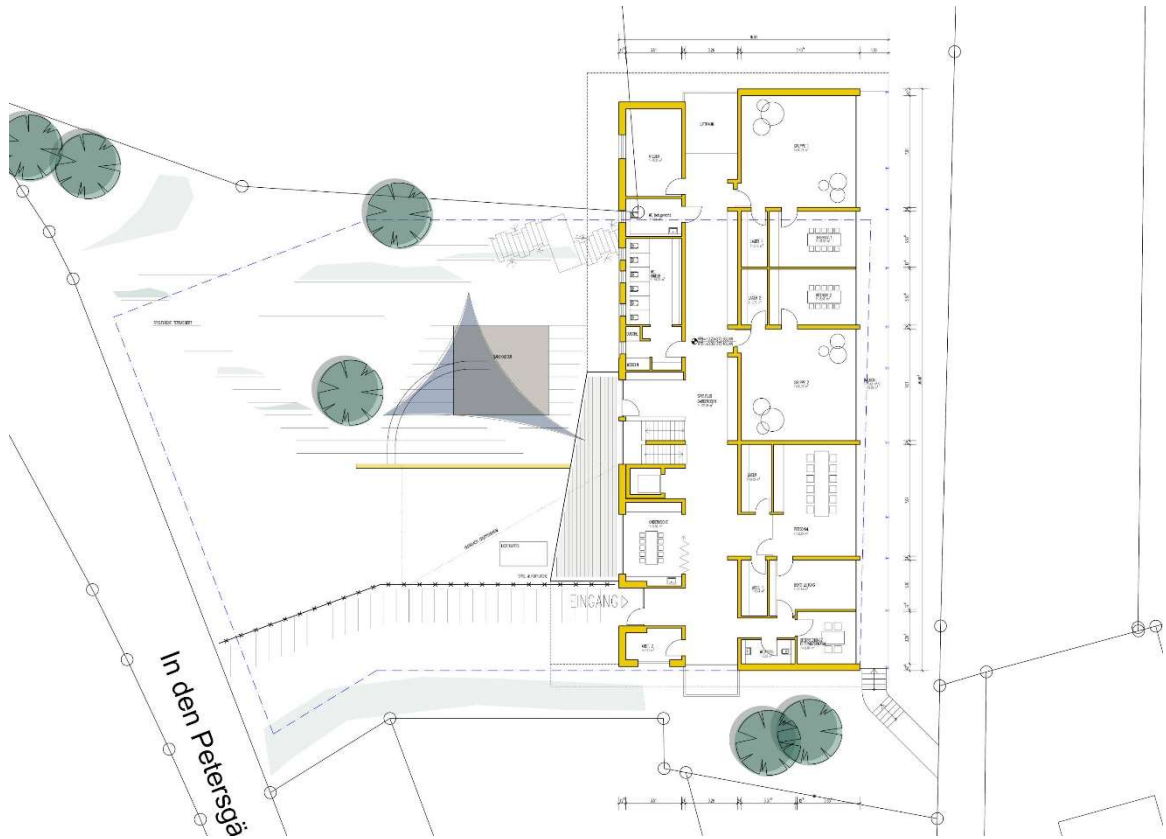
Grundriss Erdgeschoss (Quelle: O2R)
